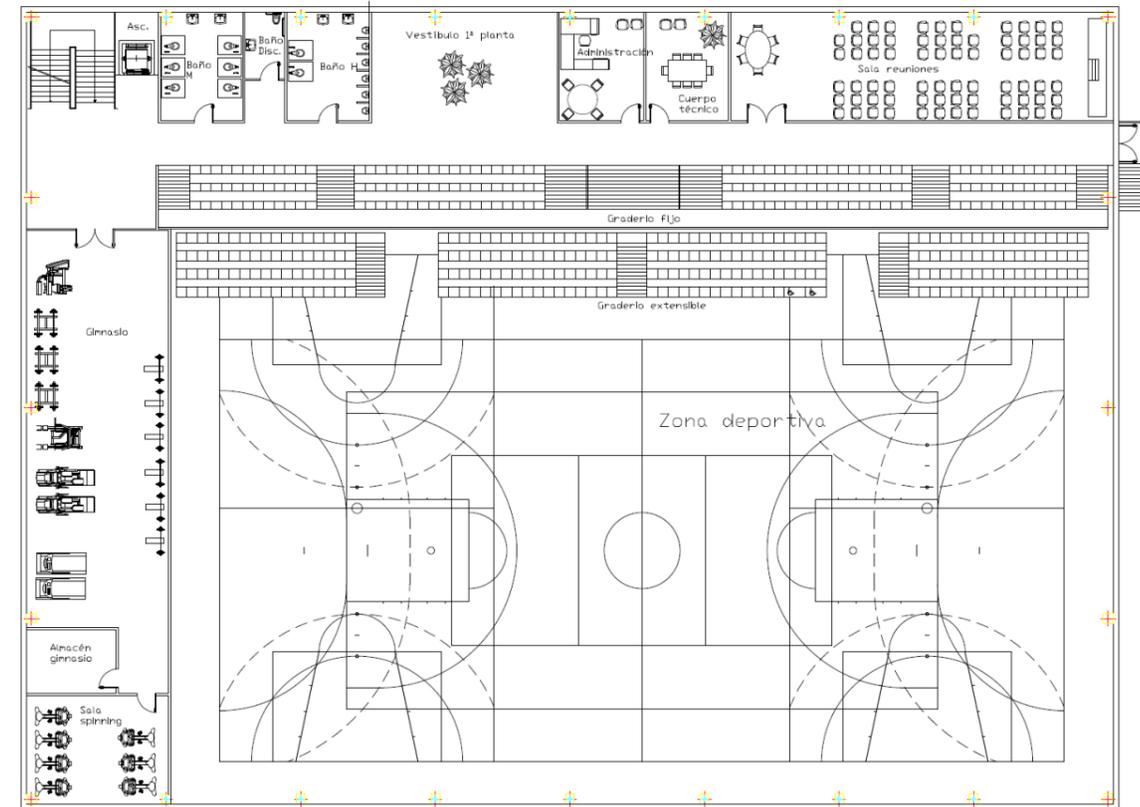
Primera planta de la solución de pabellón polideportivo adoptada.
